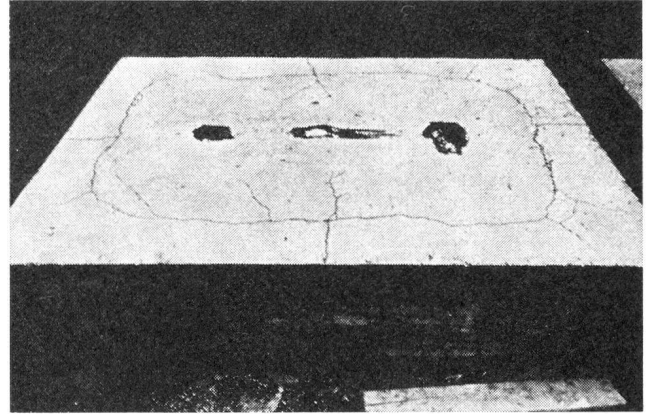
Durch Fallasten erzeugte Zerstörungen auf der Oberseite einer Betondecke
